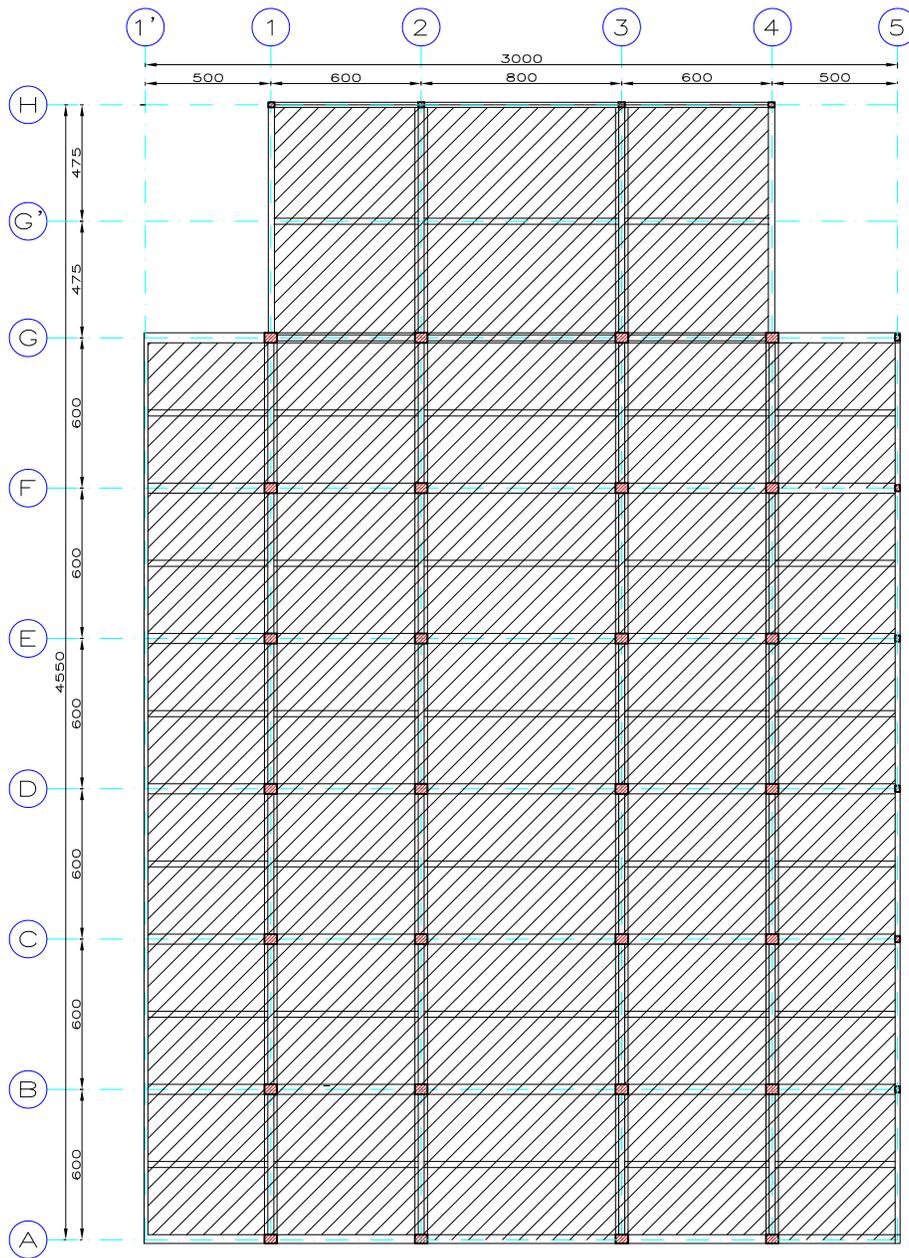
PLANTA BAJA (NTC + 2.000)
